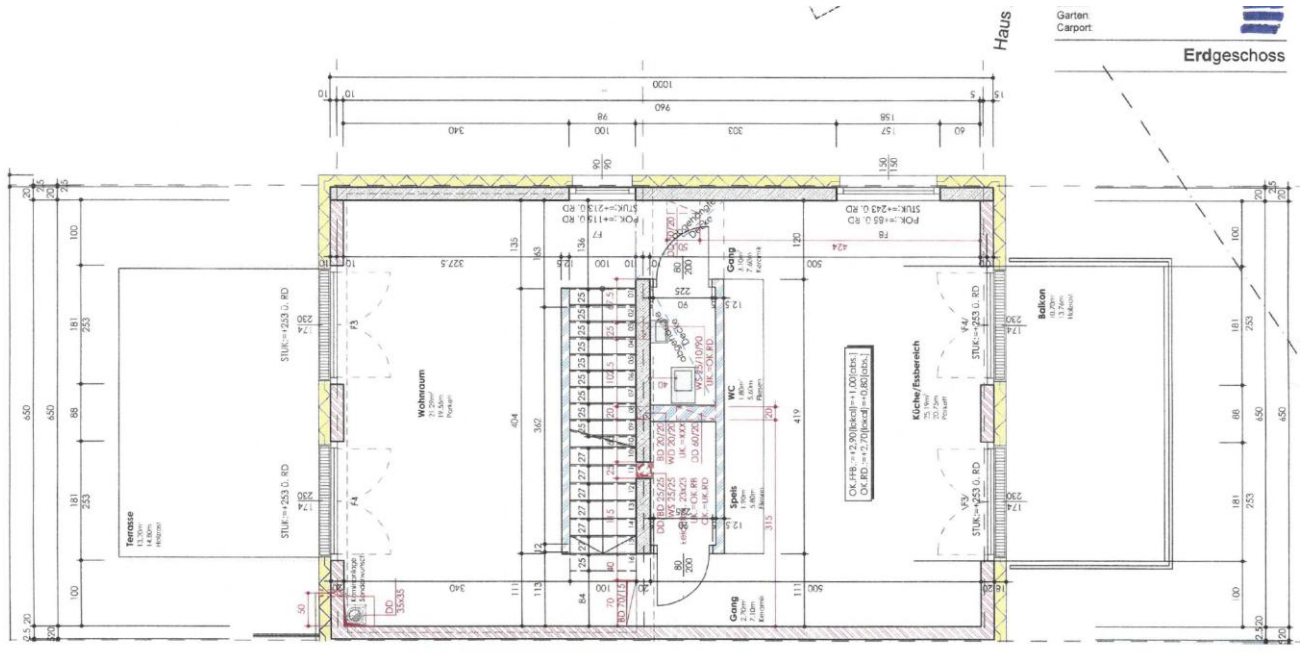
Grundriss Erdgeschoss Reihenhaus Top I1 gem. Nutzwertgutachten v. 17.04.2018¹⁶
